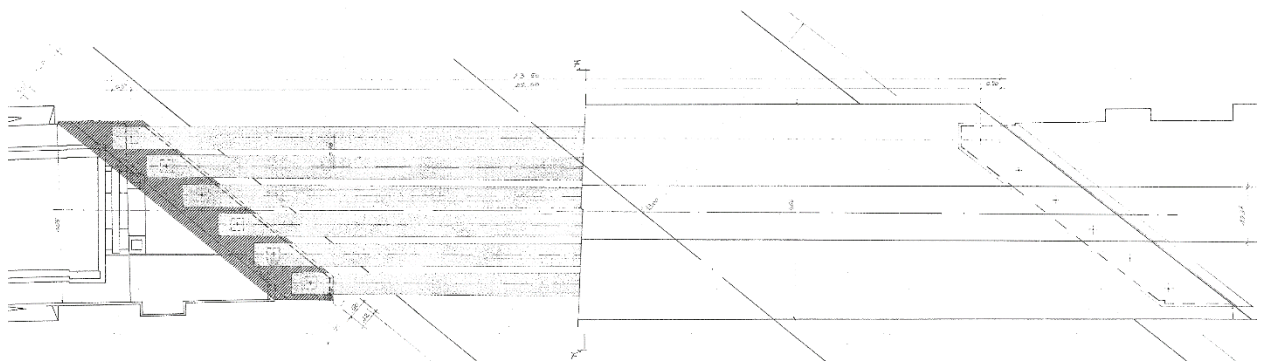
VI01 – Viadotto Gocciadoro: stralci progetto attraversamento viale Verona
